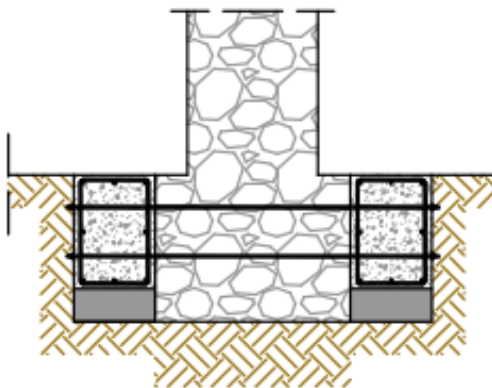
Sección zapata corrida bajo muro. Refuerzo 1. Fuente propia.
